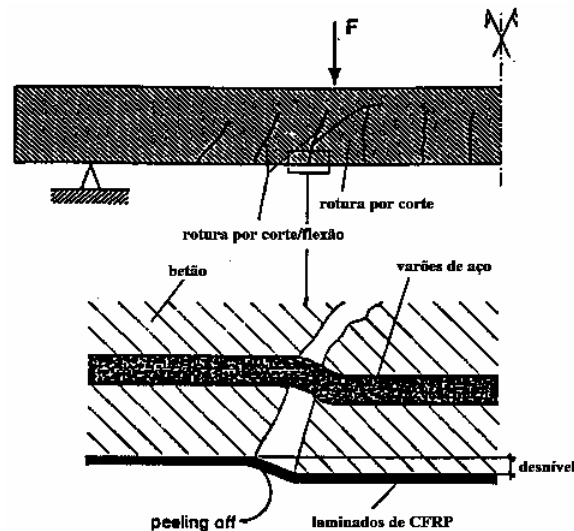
Destacamento do laminado por aparecimento de fendas de corte.
